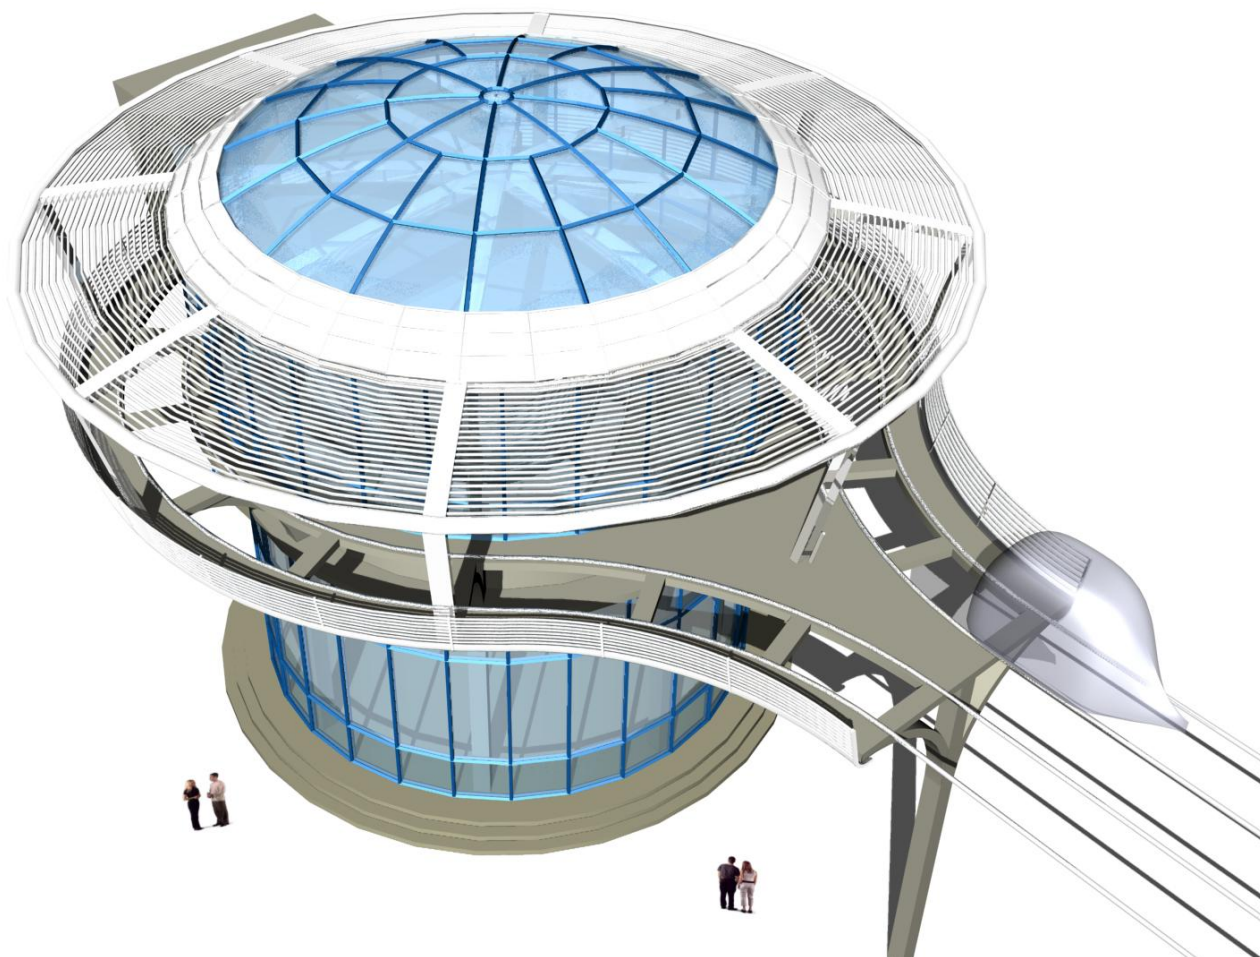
Разворотная станция двухпутного бирельсового СТЮ (вид сверху)
